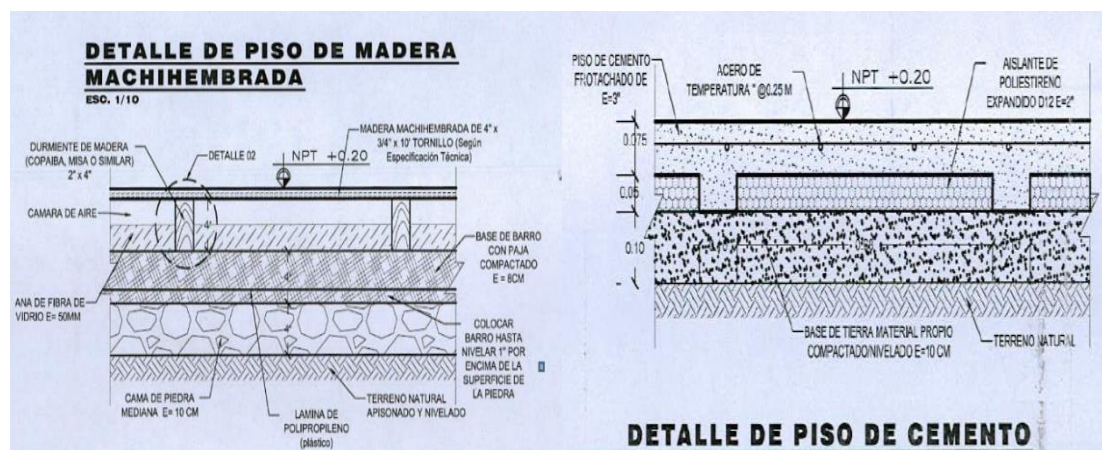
Detalle de piso de propuesta de vivienda rural PNVR
